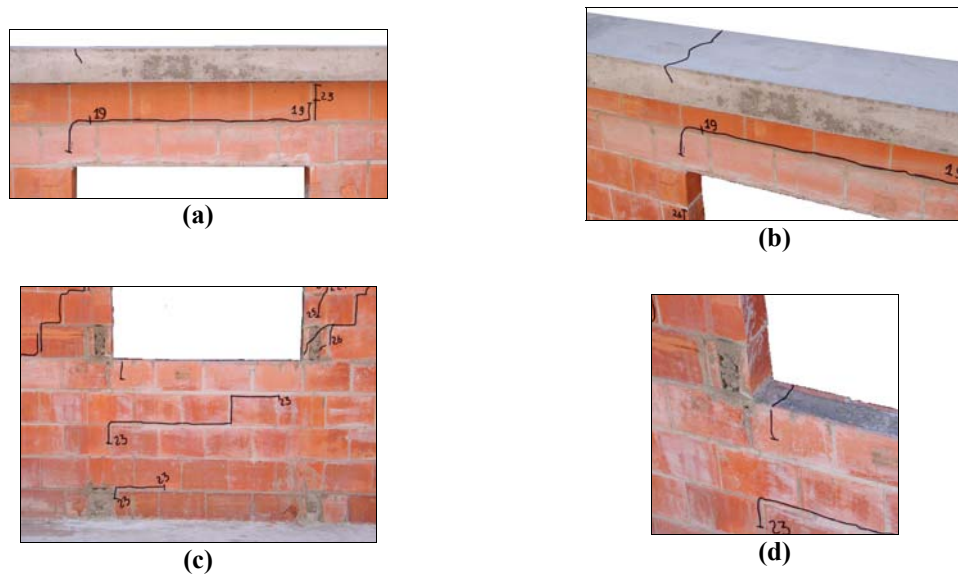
Fissuração dos lintéis do modelo PJCG1: (a) Lintel superior, (c) Detalhe da fissura na laje de topo, (c) Lintel inferior e (d) Detalhe da fissura na contraverga.
